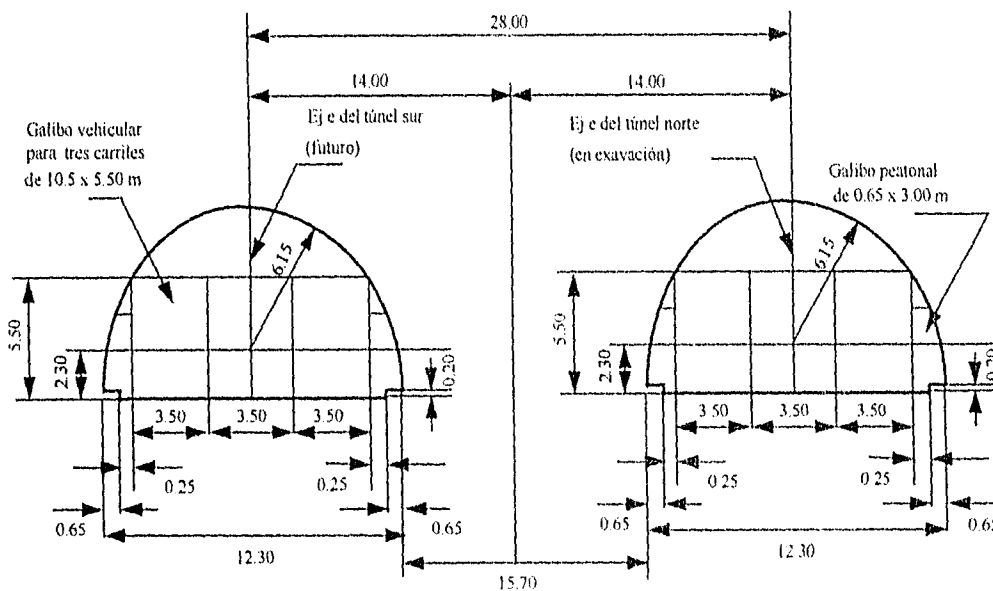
Sección transversal de los túneles gemelos de Acapulco
